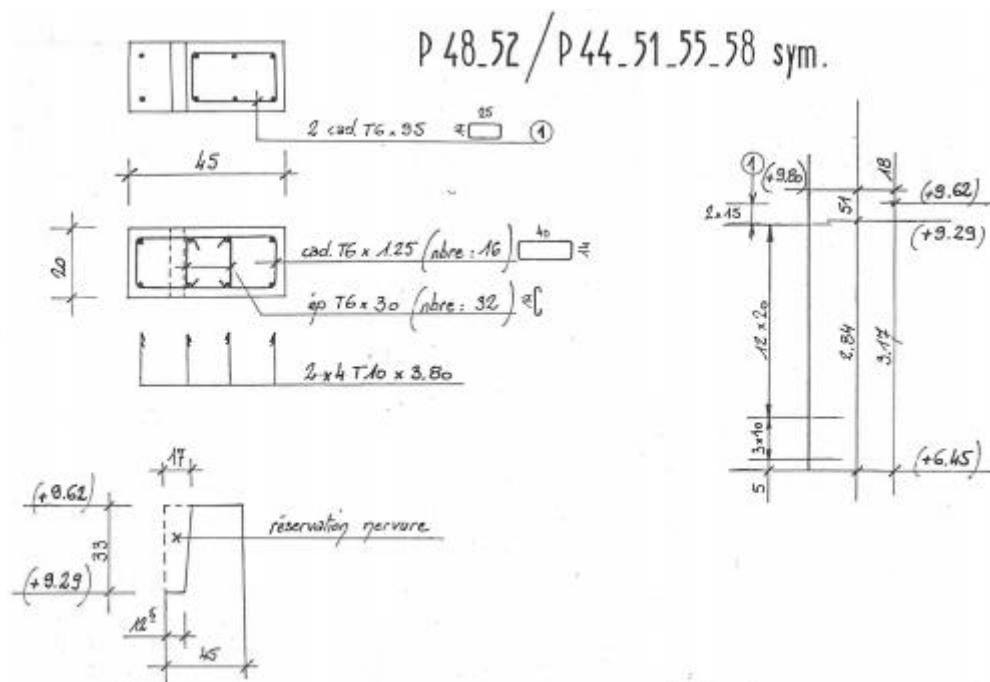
Extrait du plan de ferrailage disponible dans le Dossier des Ouvrages Exécutés du Maître d'Ouvrage pour le chantier de Lyon
